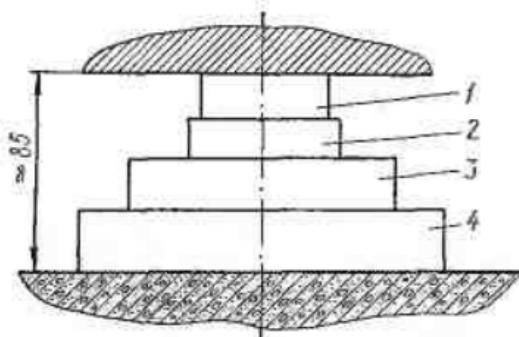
Пирамидальный пакет подкладок (по табл. 35) для фундаментного болта:
